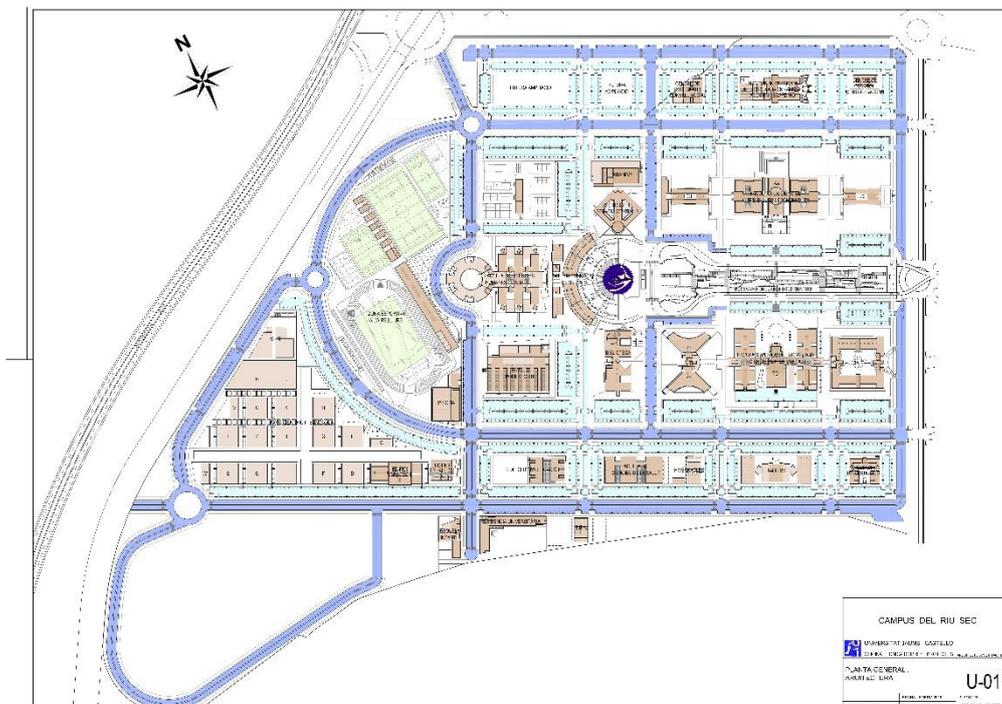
Vista en planta del campus de la Universitat Jaume I representado a escala (plano facilitado por la Oficina Técnica de Obras y Proyectos de la UJI)
